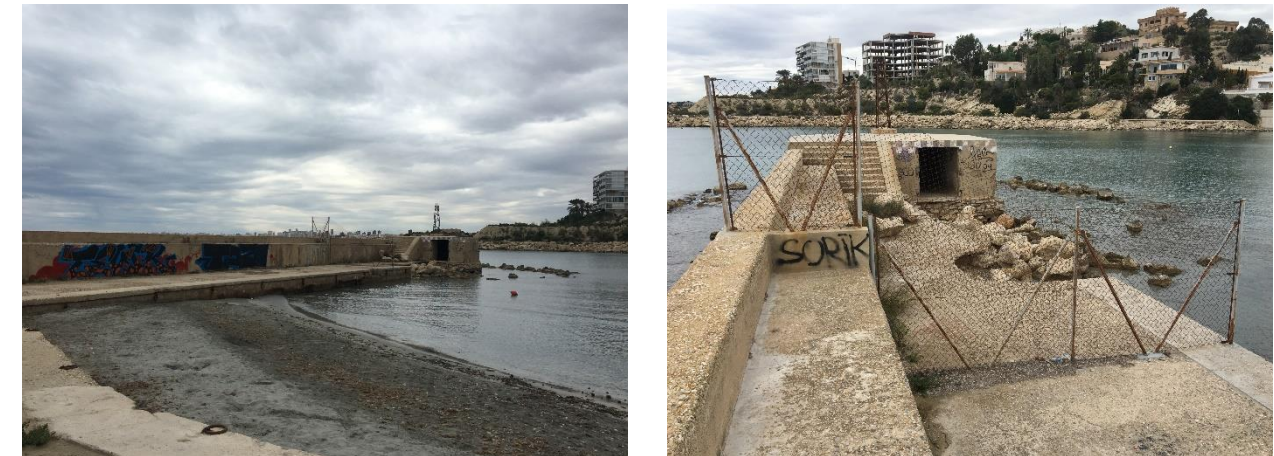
Estado actual del muelle de hormigón en el interior de la Cala Morro Blanco.
